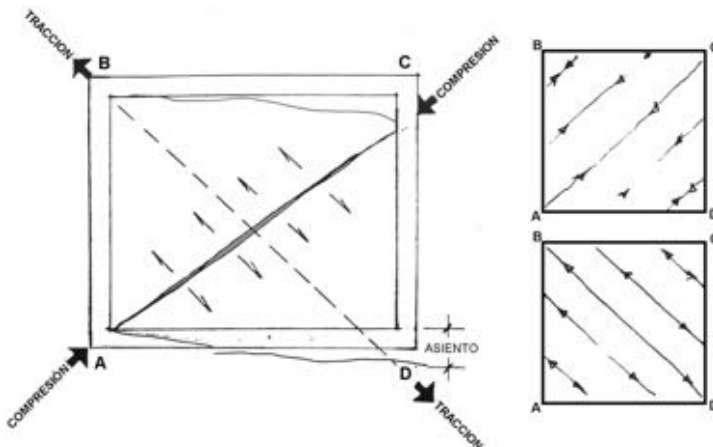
INTERPRETACIÓN DE UNA GRIETA INCLINADA
